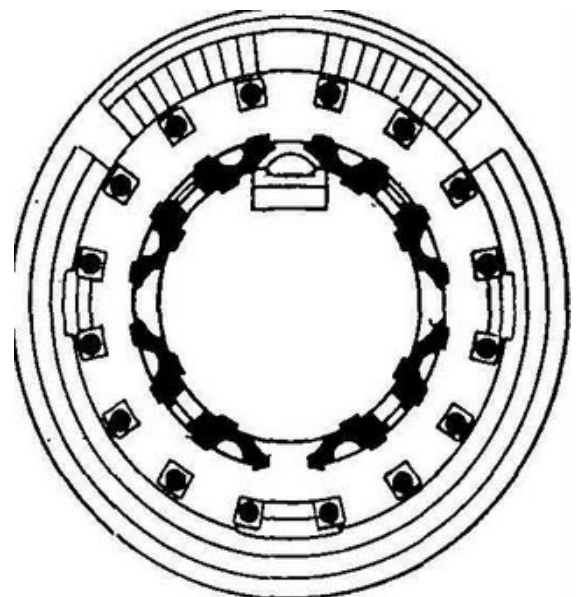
Bramante. Planta de San Pietro in Montorio
